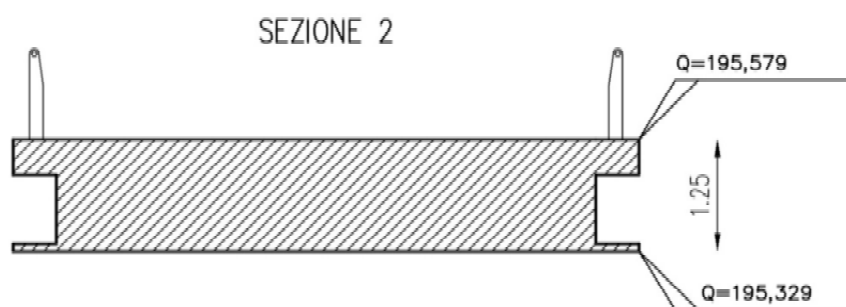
Rilievo Piacentini Ingegneri, sezione trasversale 2 sulla campata centrale
